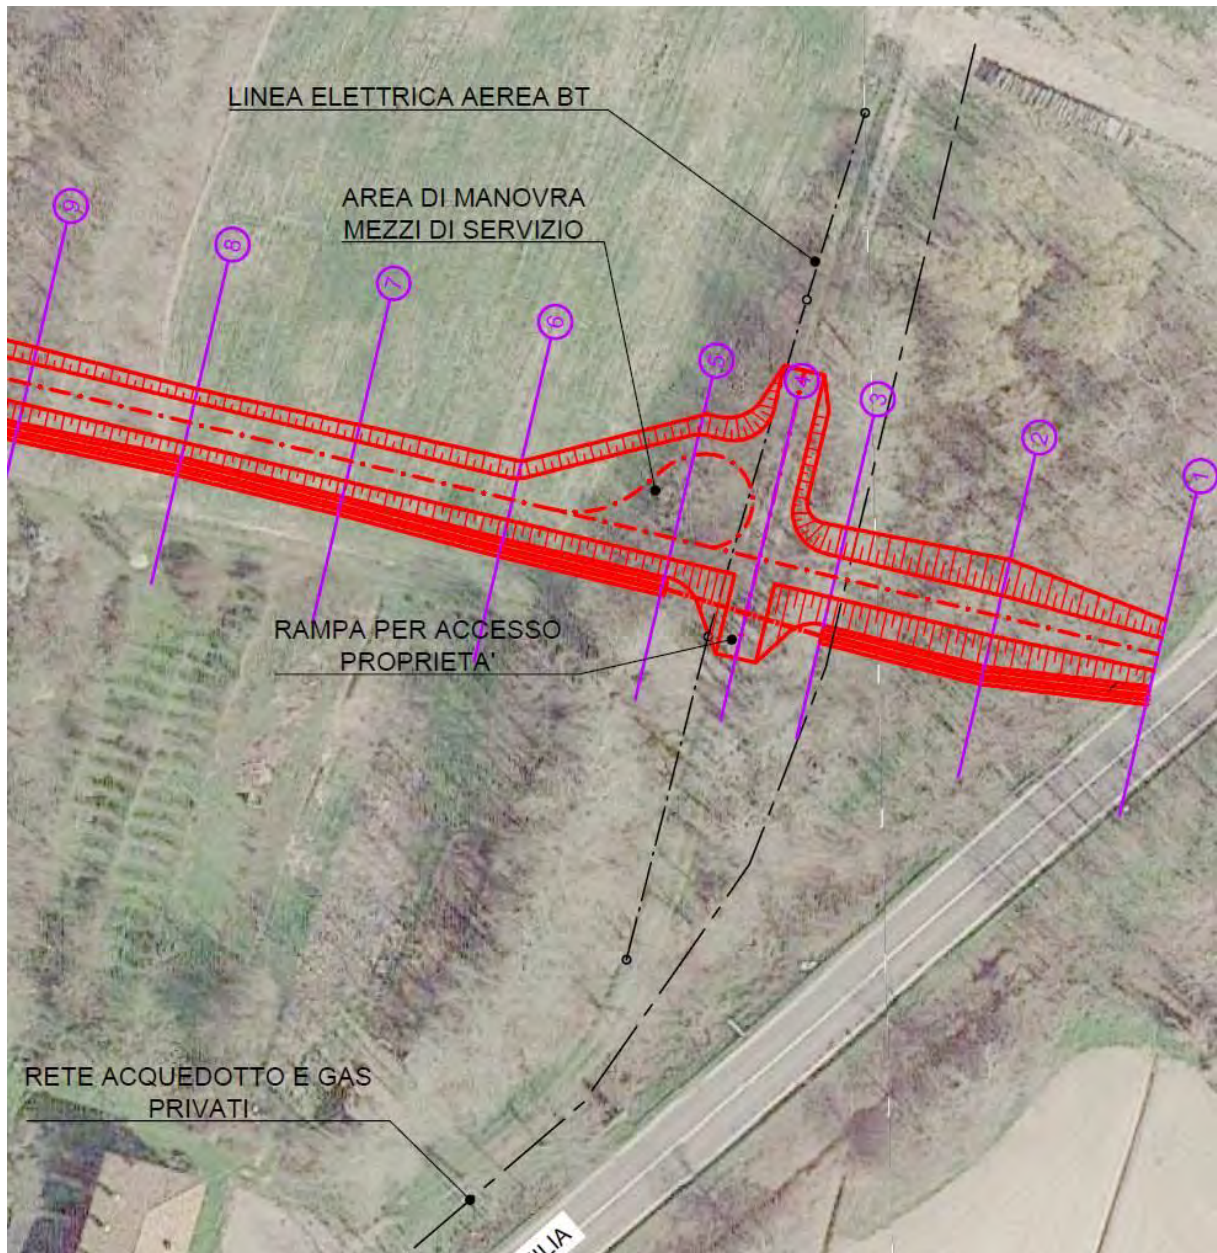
posizione linea elettrica BT, rete acquedotto e gas privato in prossimità dell'argine in progetto (stralcio planimetria di progetto).
